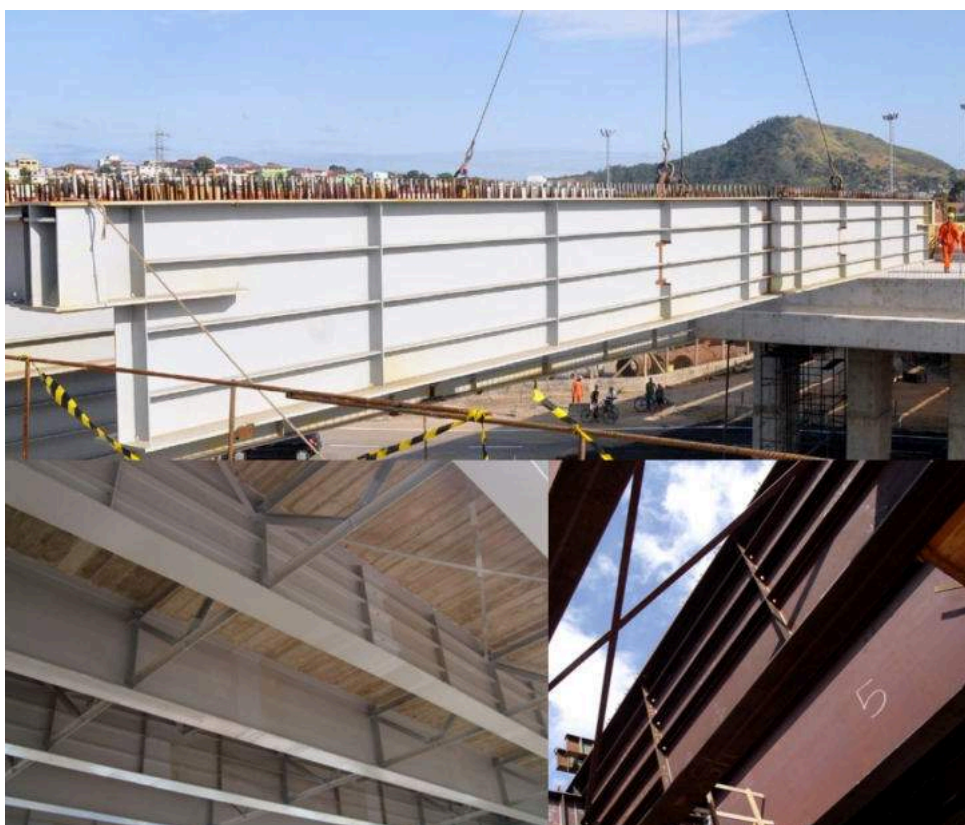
Construção de pontes e viadutos em Belo Horizonte (MG) e Vila Velha (ES) a partir de vigas esbeltas de aço com seção transversal do tipo I reforçadas por enrijecedores transversais e longitudinais. Fonte: RMG Engenharia
